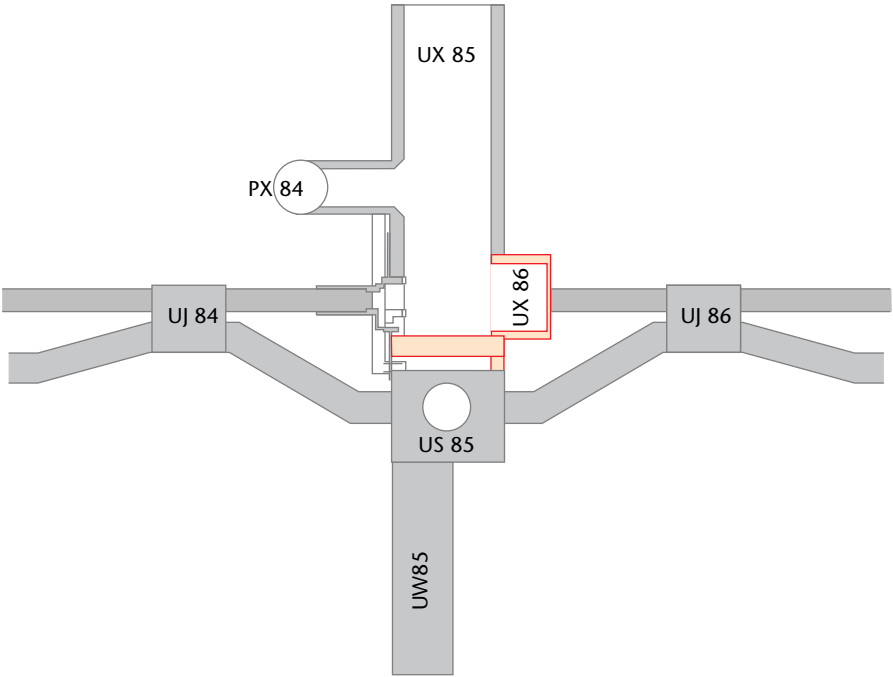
Ouvrages souterrains au Point 8 : vue en plan
